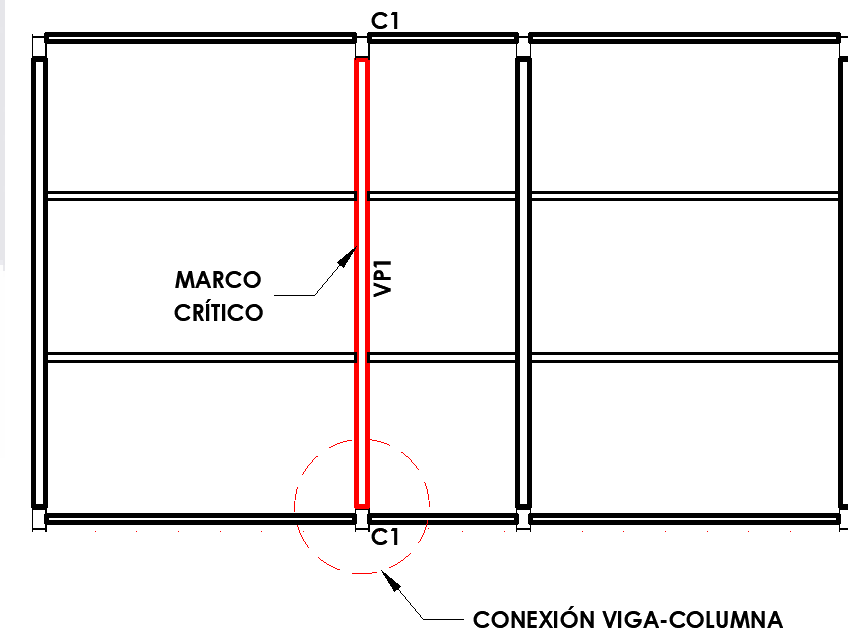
18. Detalle de conexión viga-columna elegido para la obtención de la historia de esfuerzos y análisis por fatiga.
